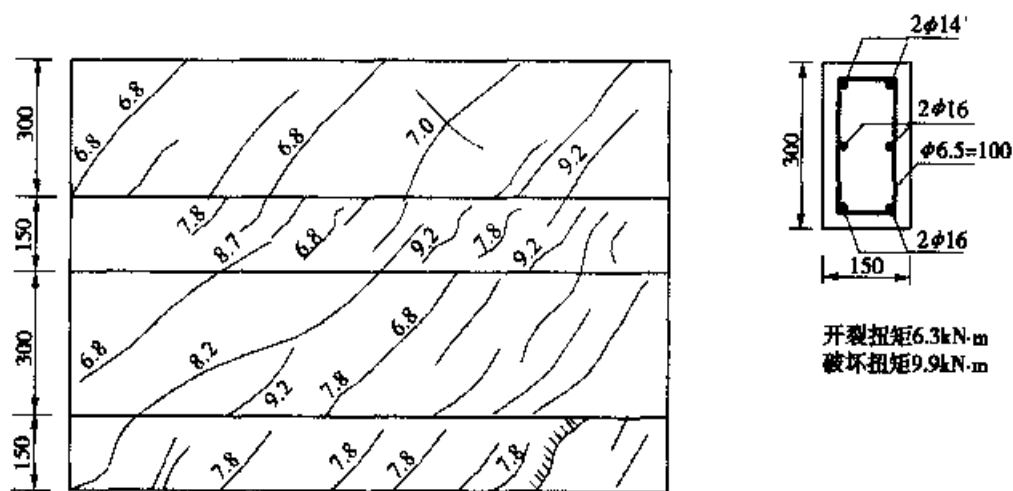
钢筋混凝土受扭试件的破坏情况(尺寸单位:cm)
